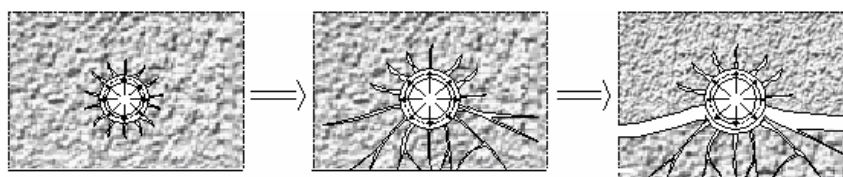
Fisurarea și dislocarea betonului în zona barei corodate
